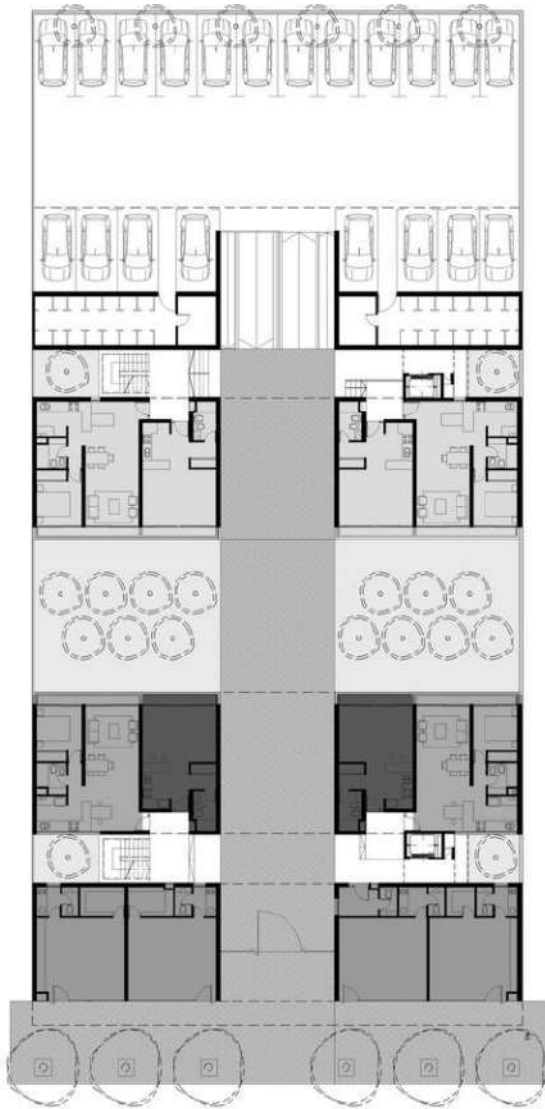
"Planta Nivel 1" Edificio 21#1324,
